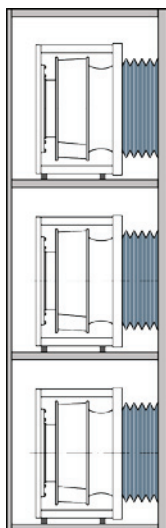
Пример установки FanGrid с RadiPac кубической конструкции
